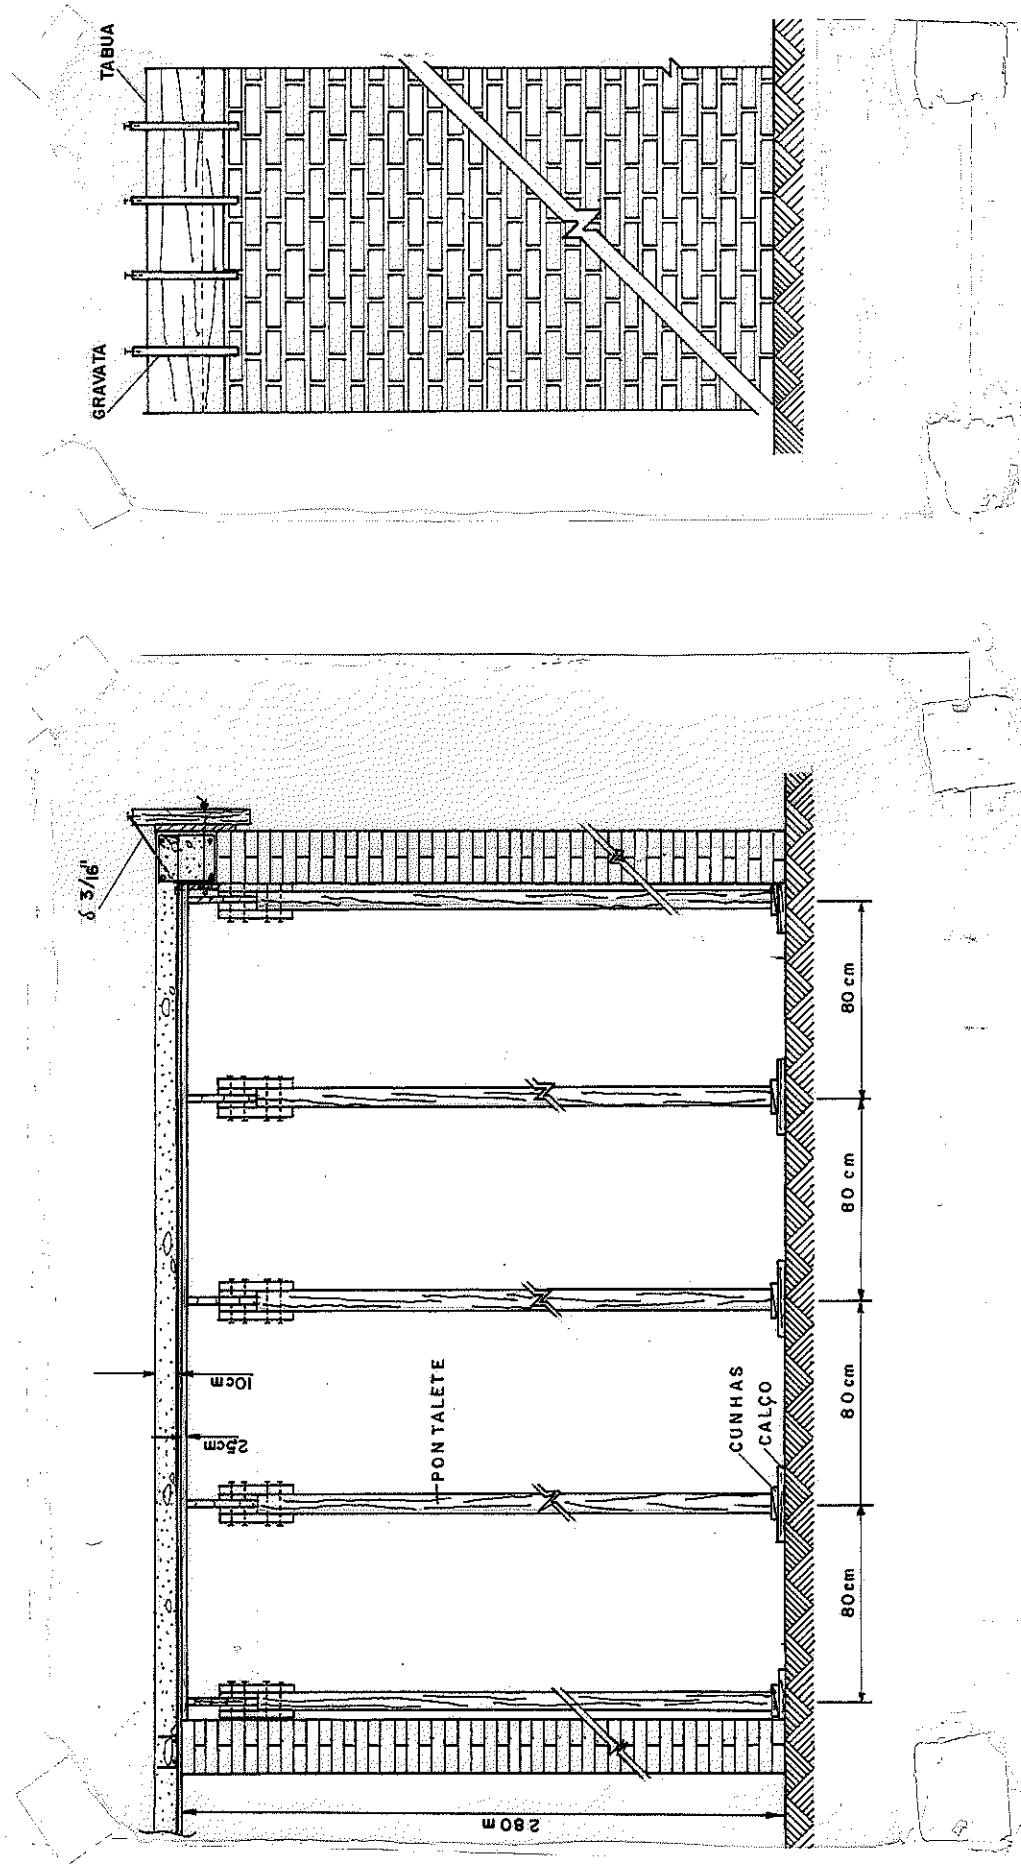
CORTE DA LAJE SOBRE ALVENARIA. DETALHES DA FORMA, DO CIMBRA -
